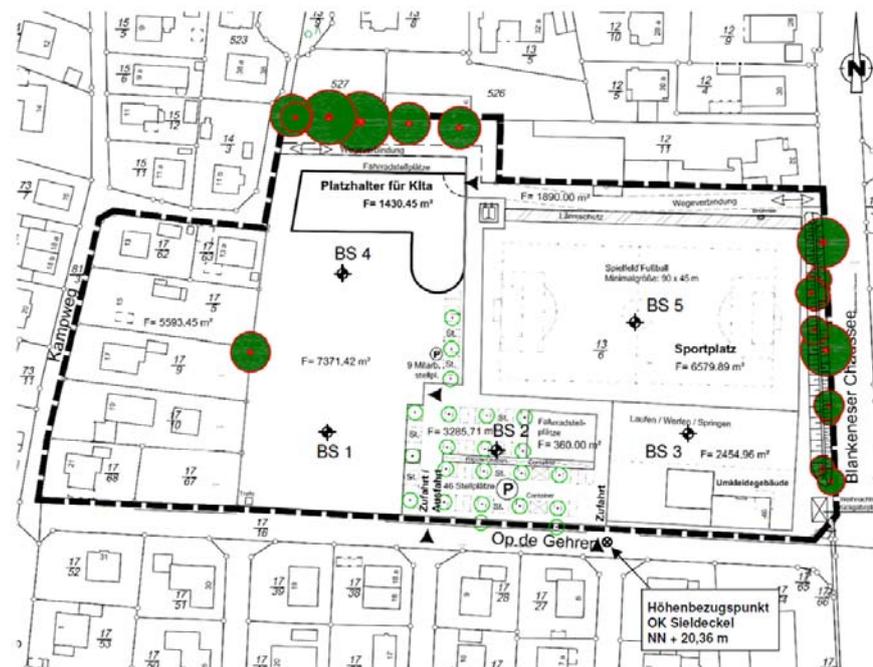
Lageplan Bohrungen Baugrundbeurteilung
